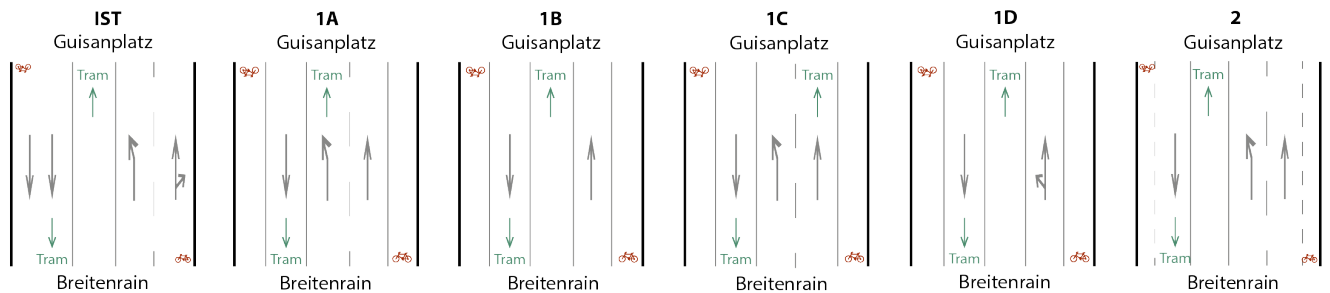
Übersichtsschema Varianten Spurlayout Rodtmattstrasse
